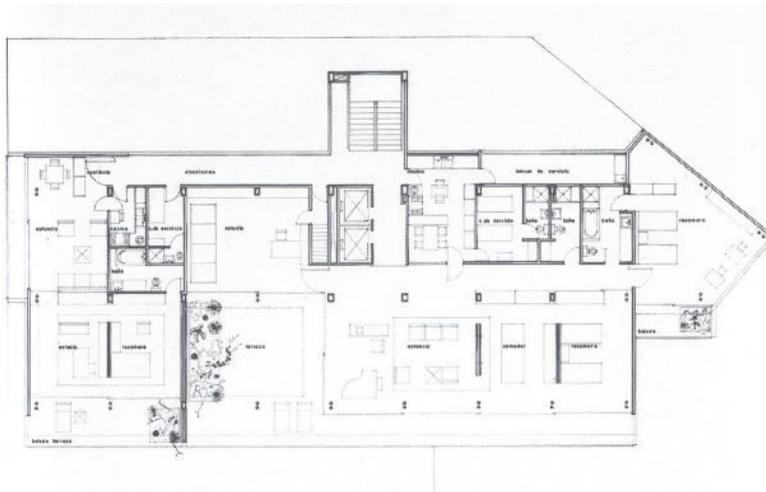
Planta pent-house del edificio ubicado en Edgar Allan Poe núm. 30, ca. 1950
